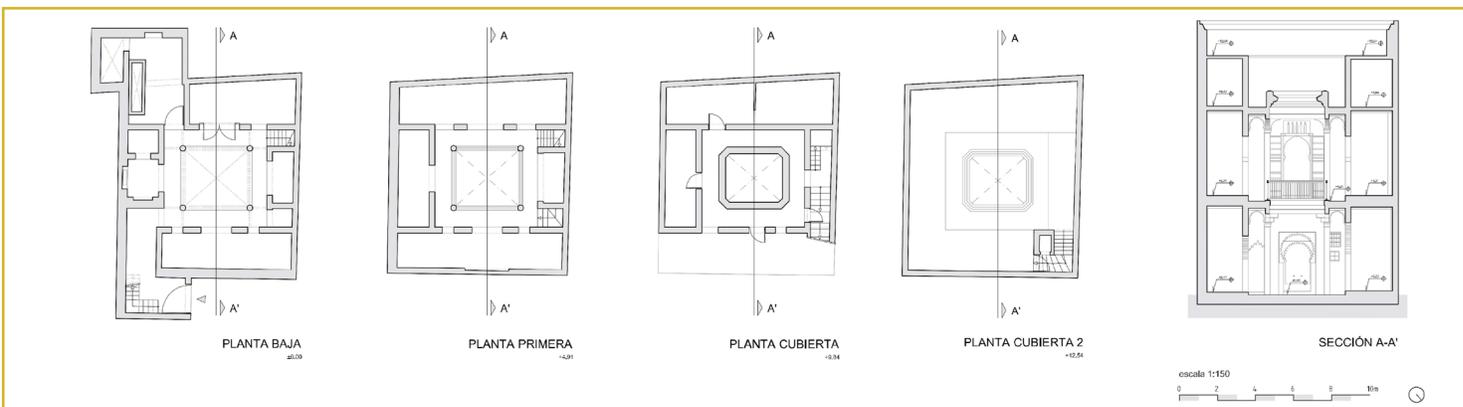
Plantas y corte de la casa dar Safar (fuente: Los autores).
